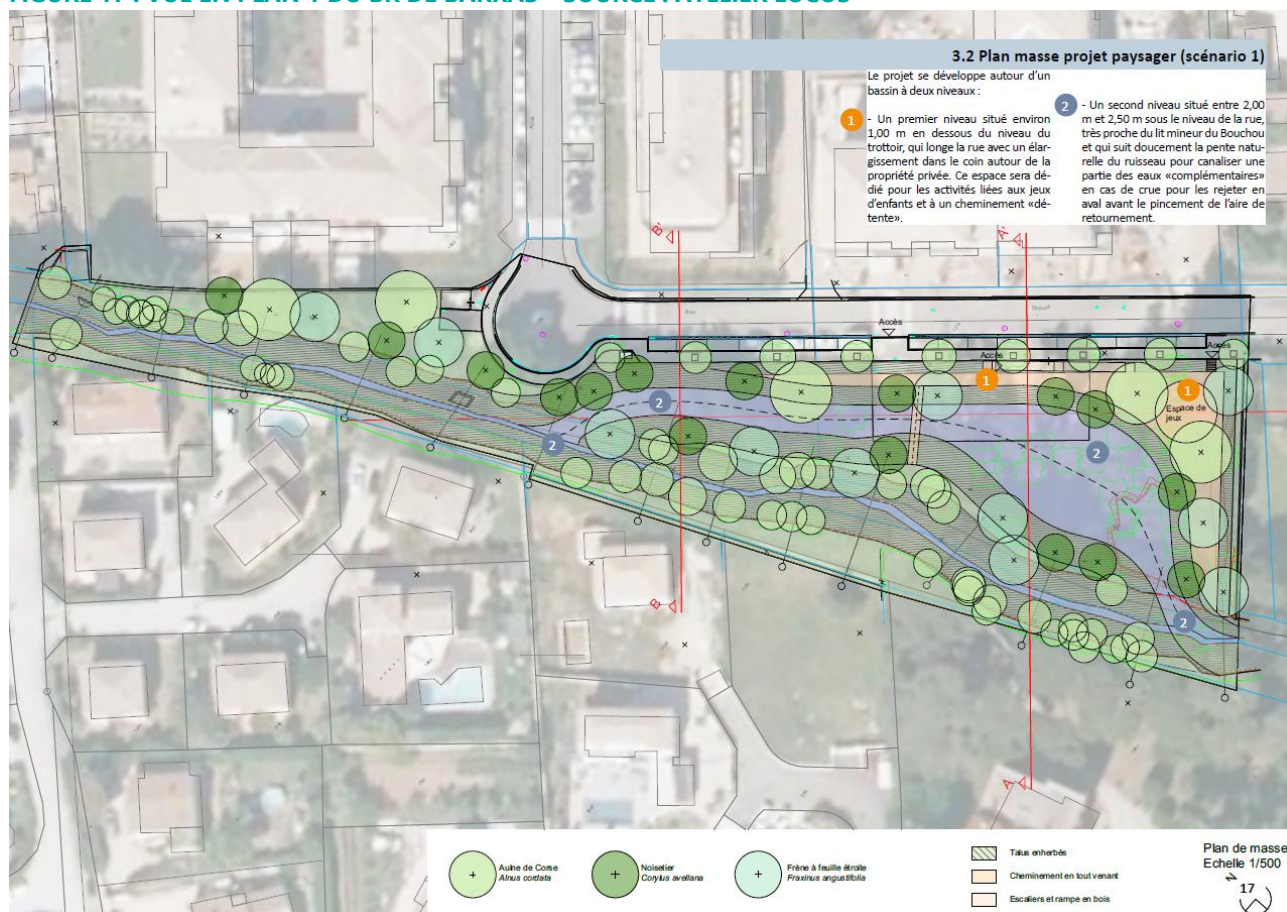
VUE EN PLAN 2 DU BR DE BARRAS – SOURCE : ATELIER LOCUS
